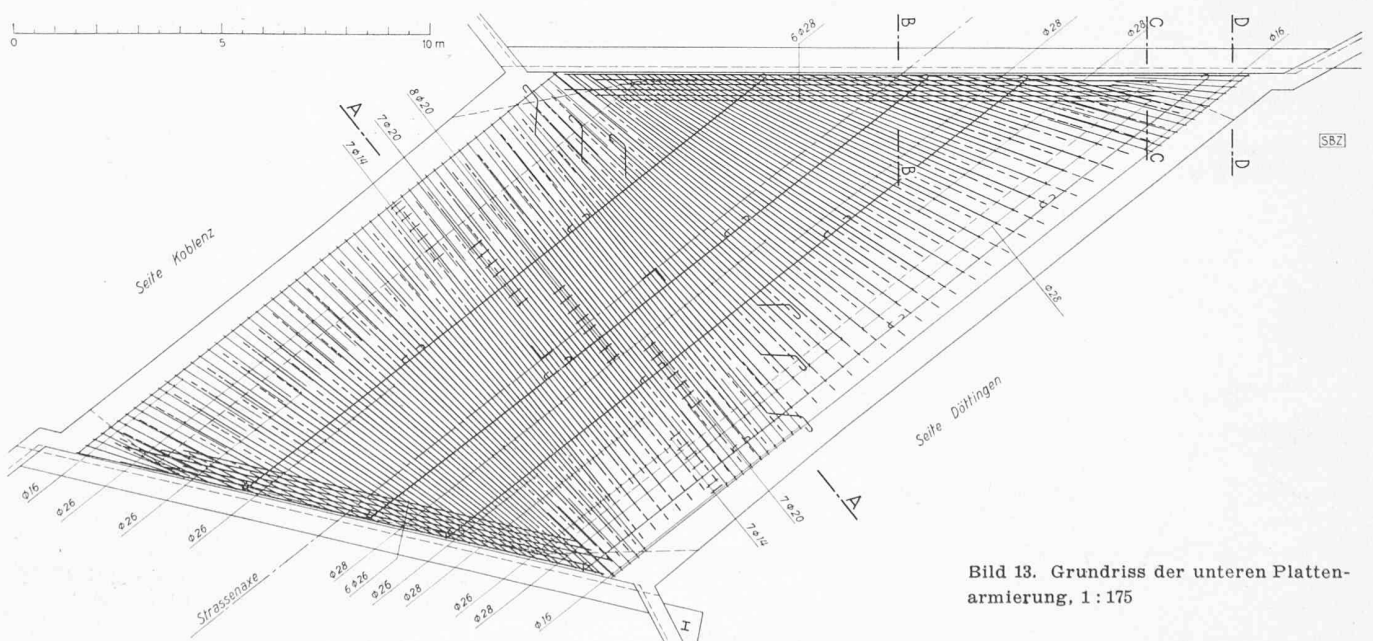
Grundriss der unteren Plattenarmierung, 1 : 175
